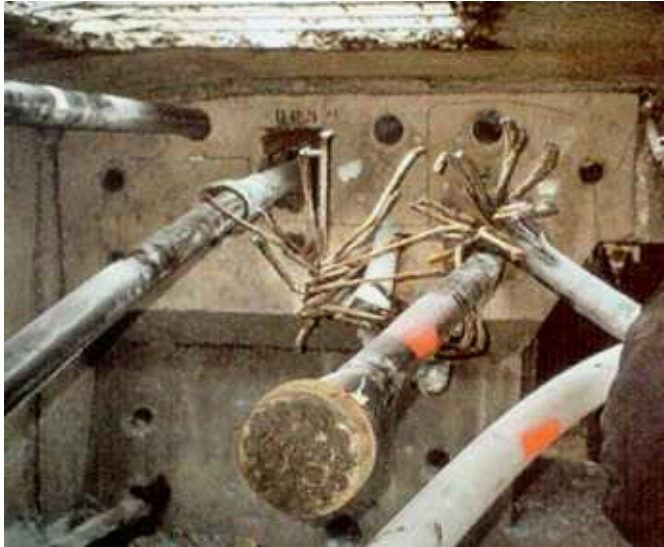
exemple d'éjections de têtes d'ancrage (crédit photo D. Poineau)
